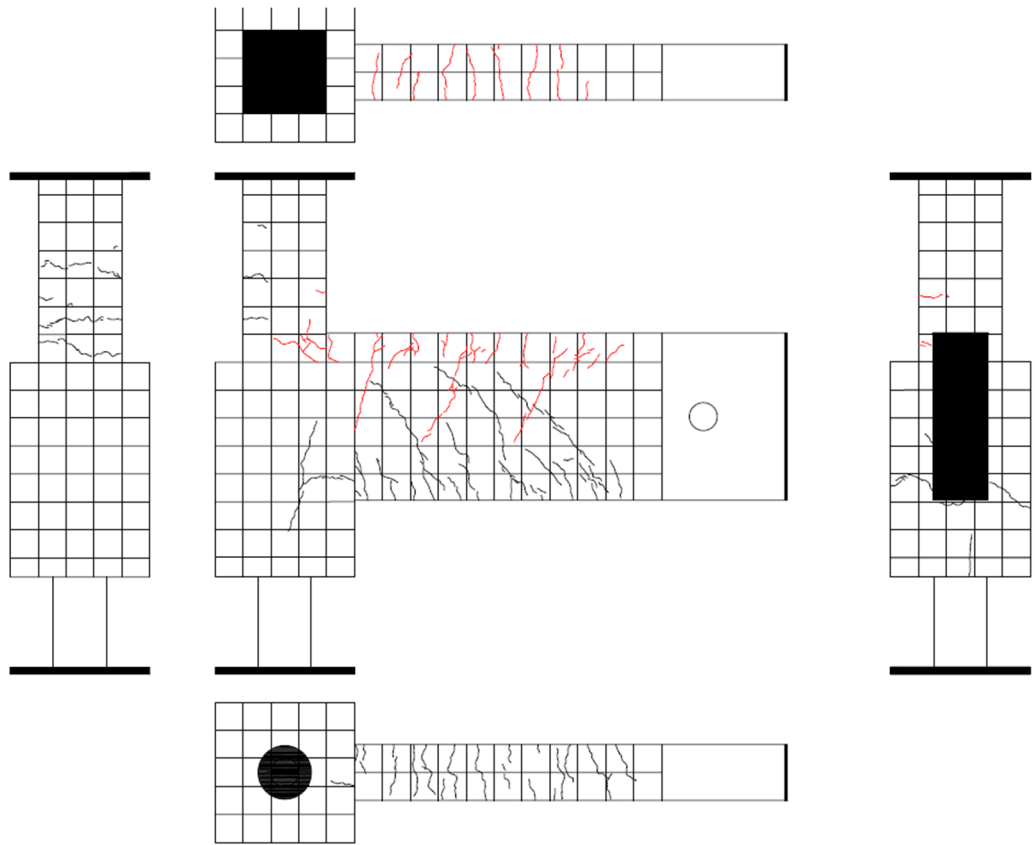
試験体 D-3 ひび割れ状況 (20cycle)
